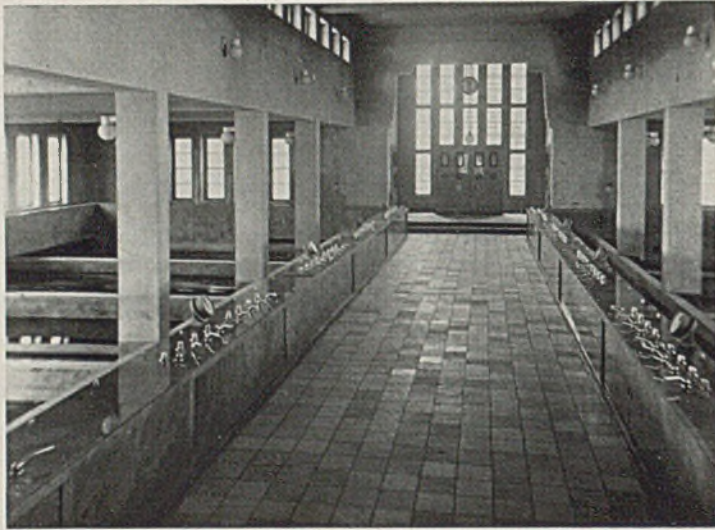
Blick in das Innere des neuen Schnellfiltergebäudes an der Geigenbachtalsperre der Kreisstadt Plauen i. V.
